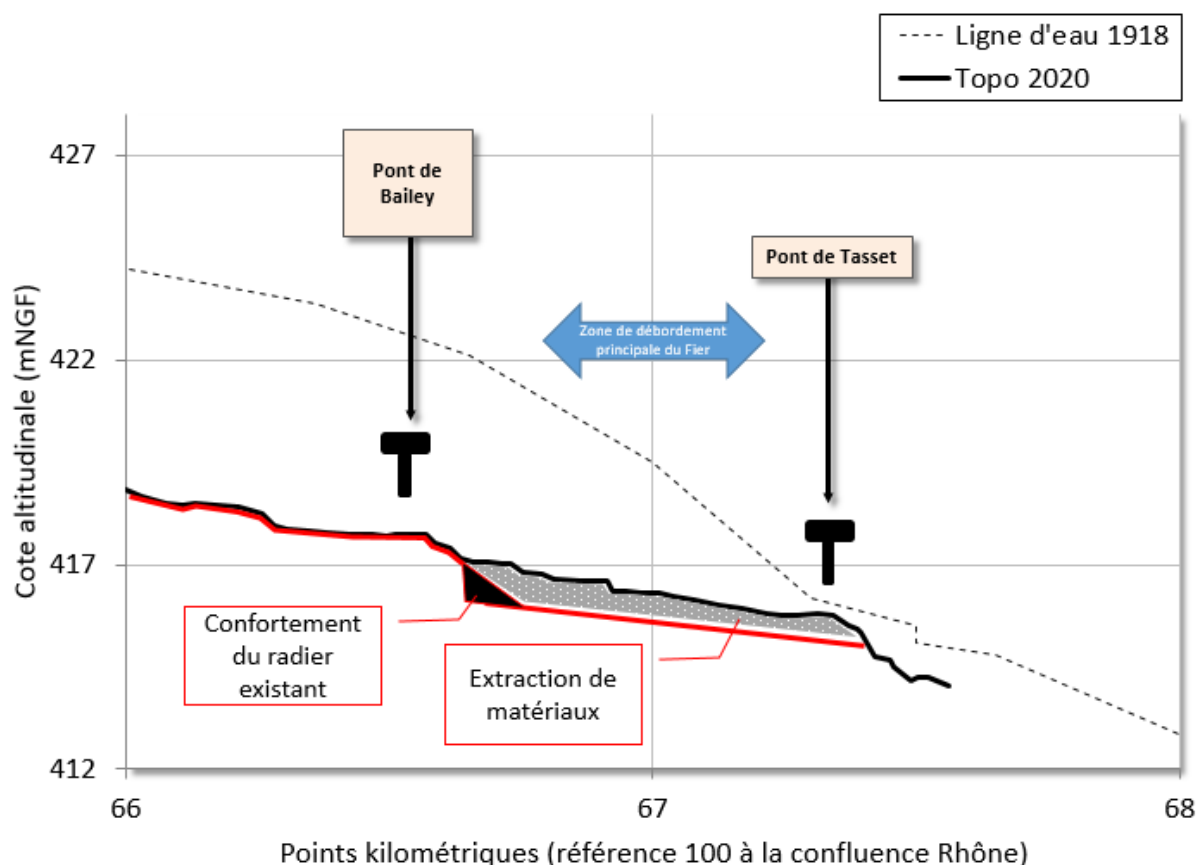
Principe de l'action de protection du risque inondation suite à l'exhaussement du Fier entre le pont de Tasset et le pont de Bailey
